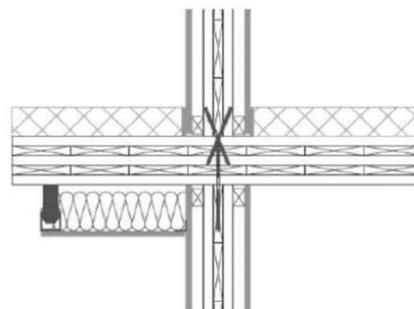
Appui entre panneaux de mur et de plancher assemblé par vissage
